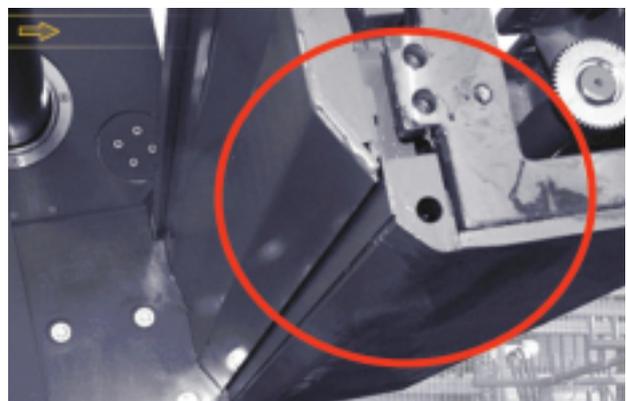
Tamper, Bohlenglättblech mit Vibration
